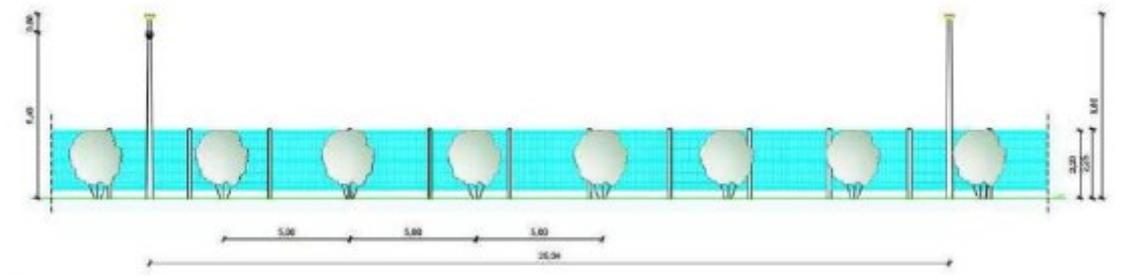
Prospetto frontale della fila di piante di alloro della siepe di mitigazione perimetrale.
